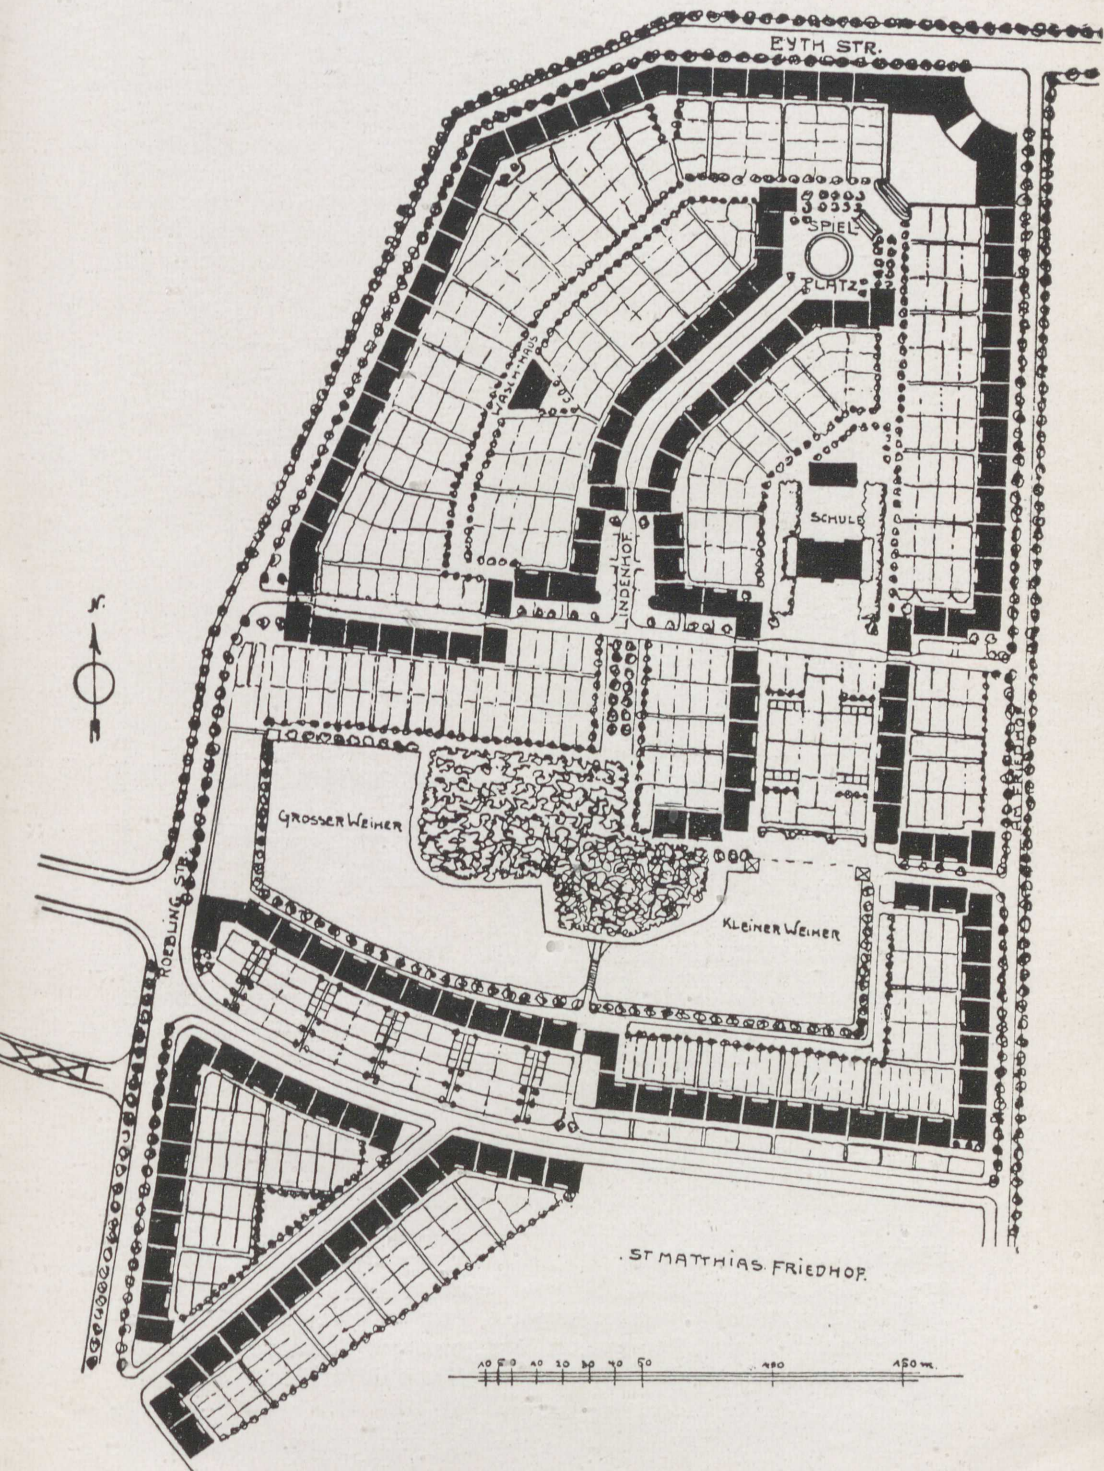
Lageplan der Siedlung Kolonie Lindenhof in Schöneberg.
